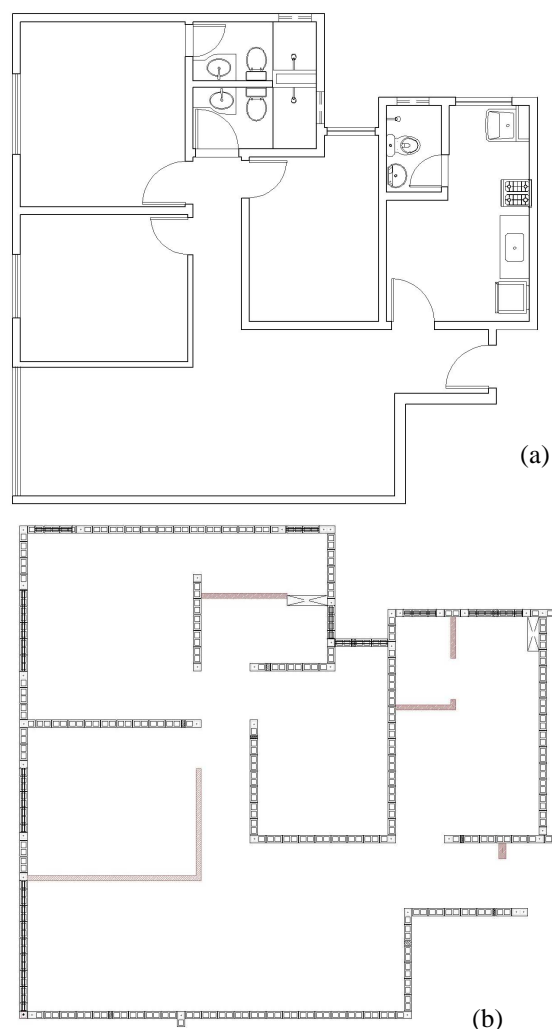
Planta de apartamento de três quartos de edifício em alvenaria estrutural localizado em Águas Claras – DF (a) e sua equivalente planta de execução (b).
